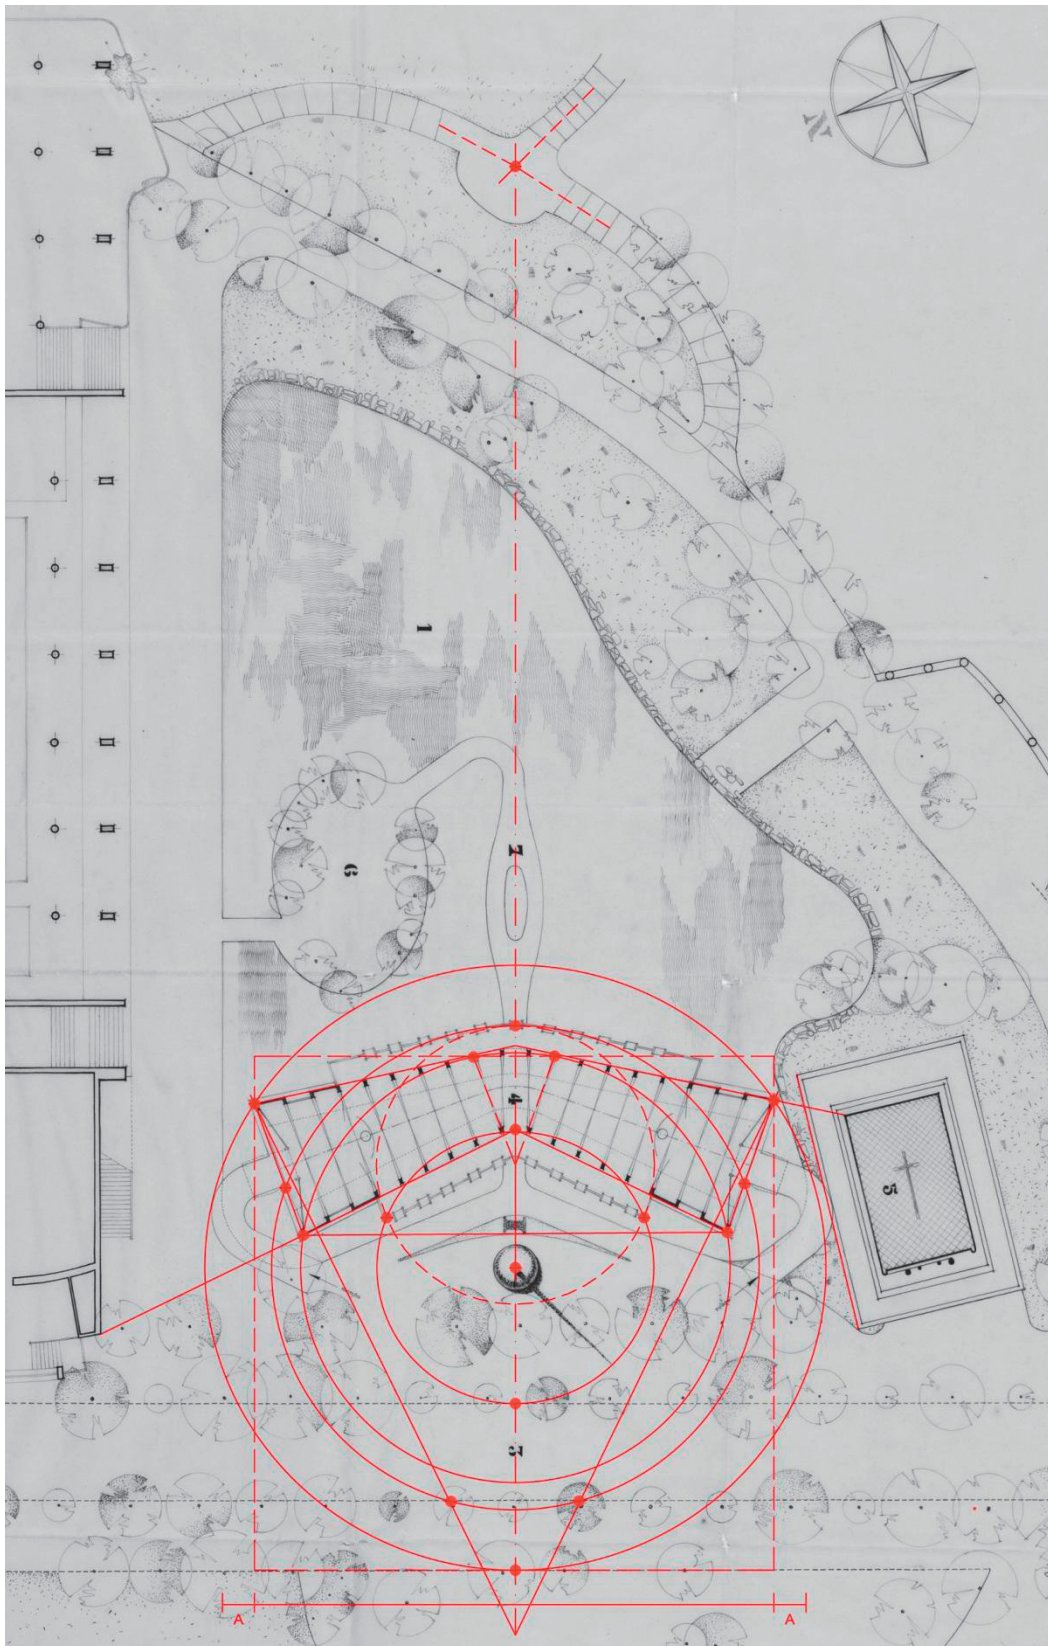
Helder Casal Ribeiro, Pavilhão das Ilhas Adjacentes, linhas estruturais da implantação
